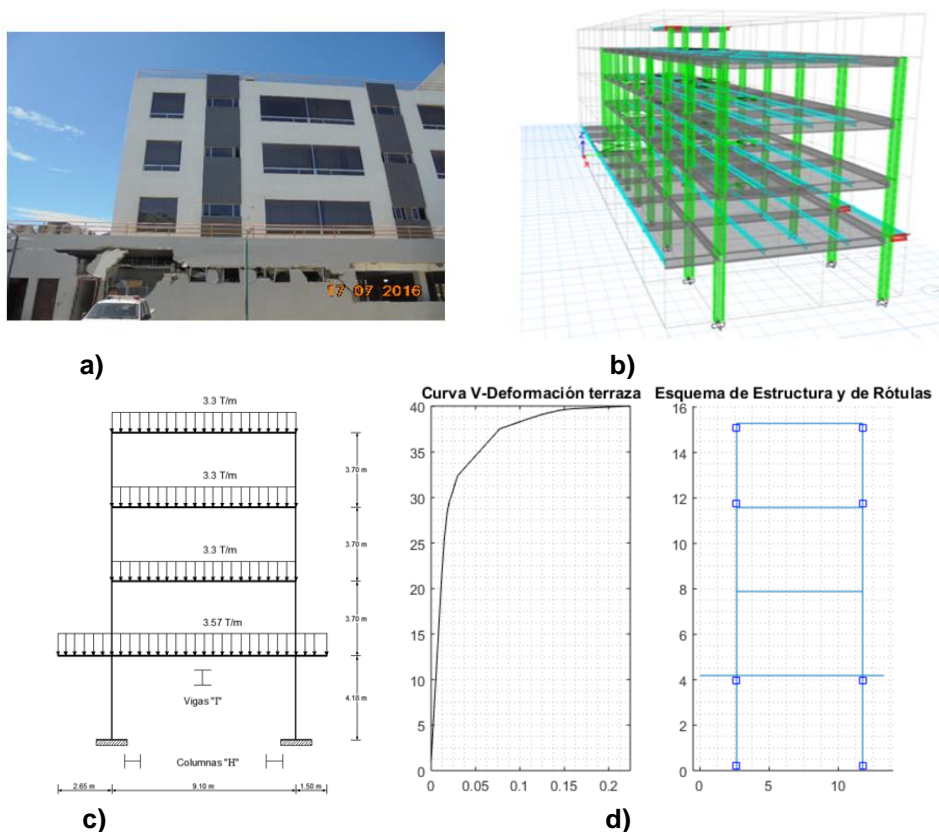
Edificio UVC de Manta; a) Estructura con daño en mampostería; b) Configuración Estructural; c) Pórtico Tipo; d) Curva de capacidad sísmica resistente de pórtico tipo.
